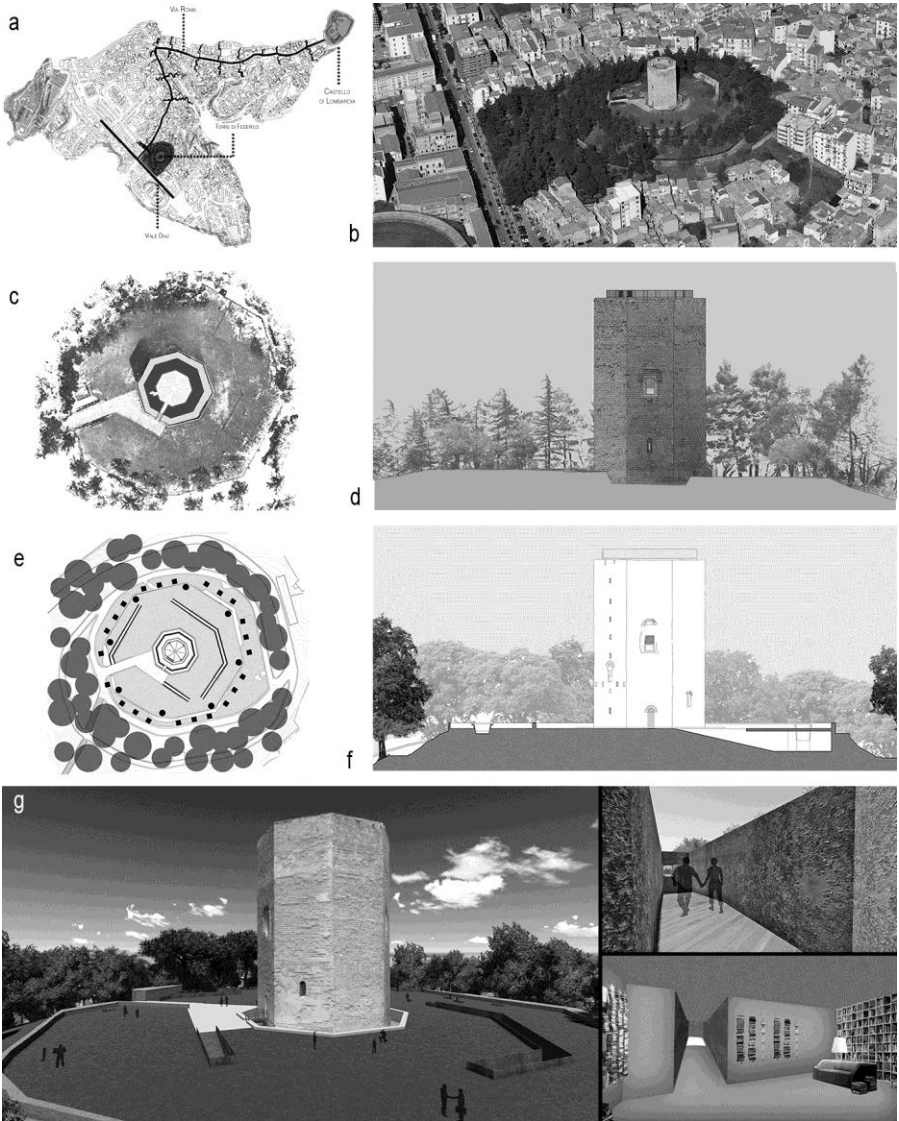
a) Inquadramento urbano; b) vista aerea della torre di Federico e del parco circostante; c) rilievo 3D *laser scanning*: planimetria e d) alzato; e) planimetria, f) sezione e g) viste render del progetto.
